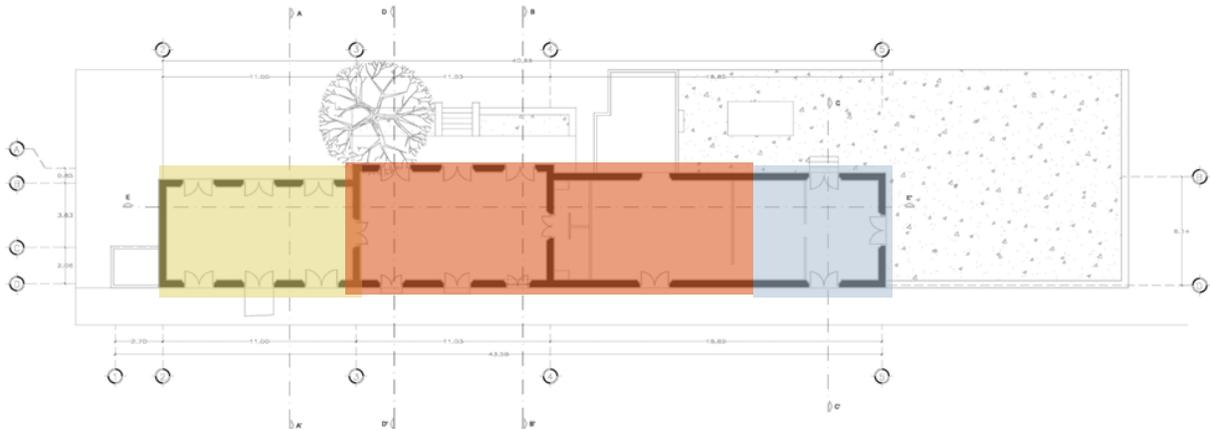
Planta Arquitectónica Ex Estación de Trenes de Acanceh, PGPL 2016
